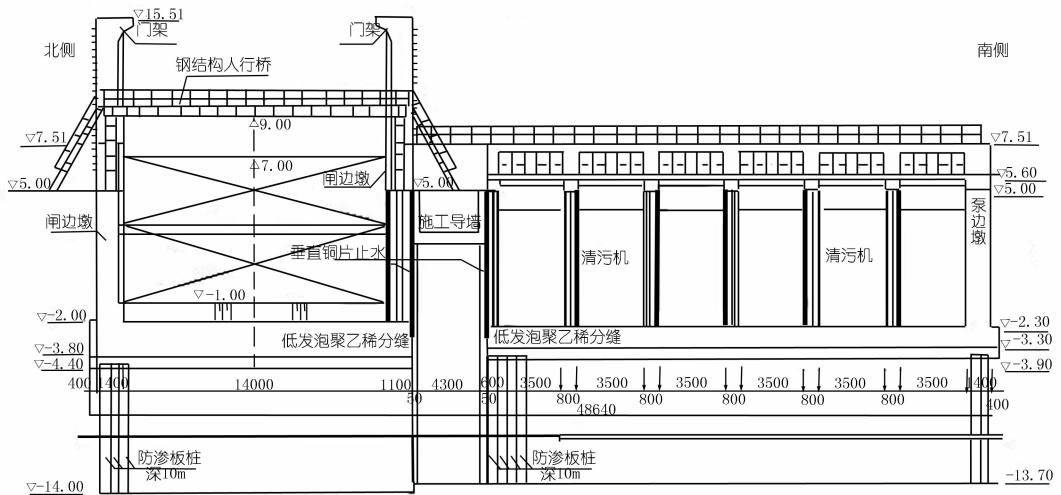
节制闸闸室横剖剖面(尺寸单位:mm)
